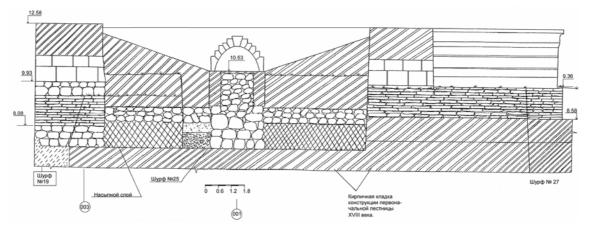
Схематический разрез опорных конструкций западной лестницы по оси «Ц»
